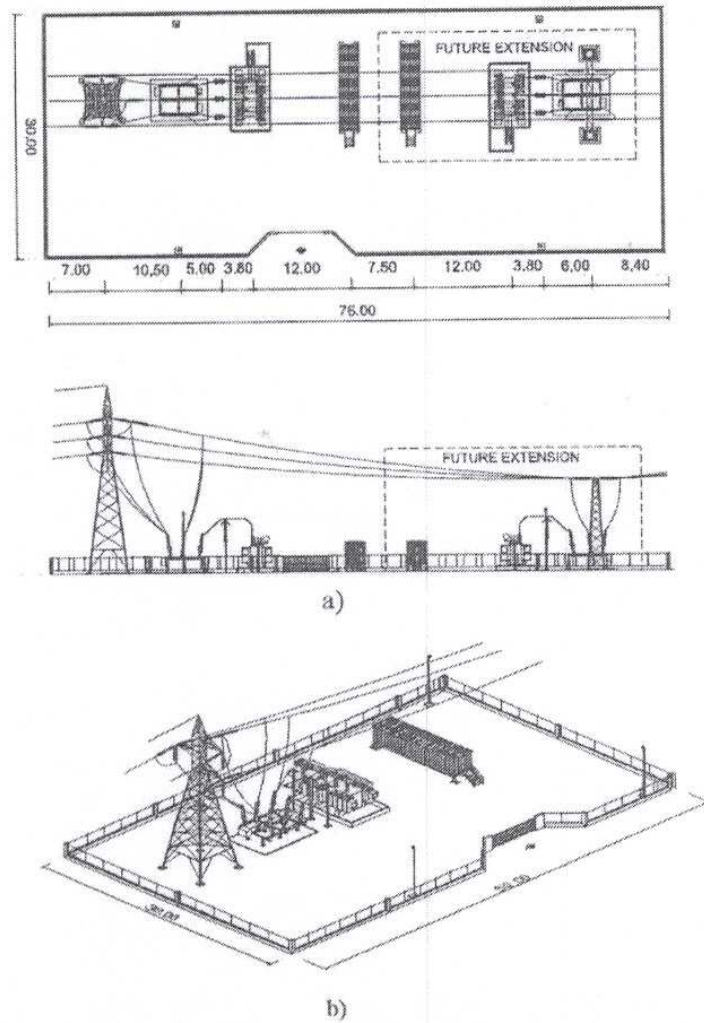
Pianta e sezione longitudinale (a) e veduta tridimensionale (b) di una stazione compatta a 170 kV realizzata secondo lo schema “C” di Fig. 16
